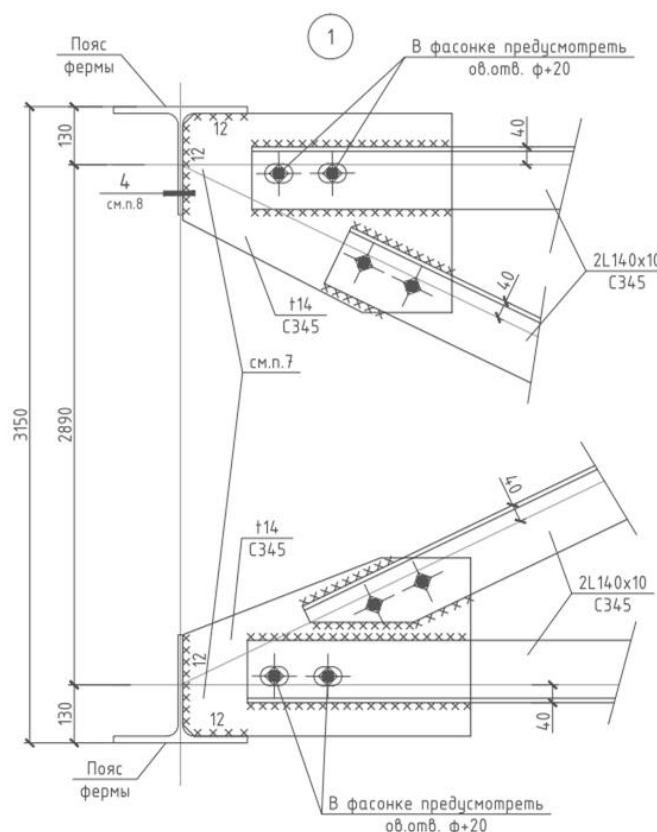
Примыкание вертикальных связевых ферм к стропильным фермам
